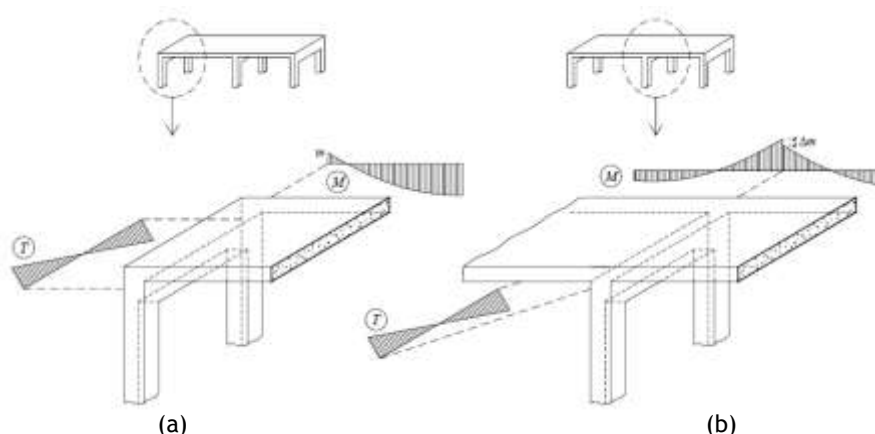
(a) Viga de apoio de extremidade; (b) viga de apoio de continuidade [17]
